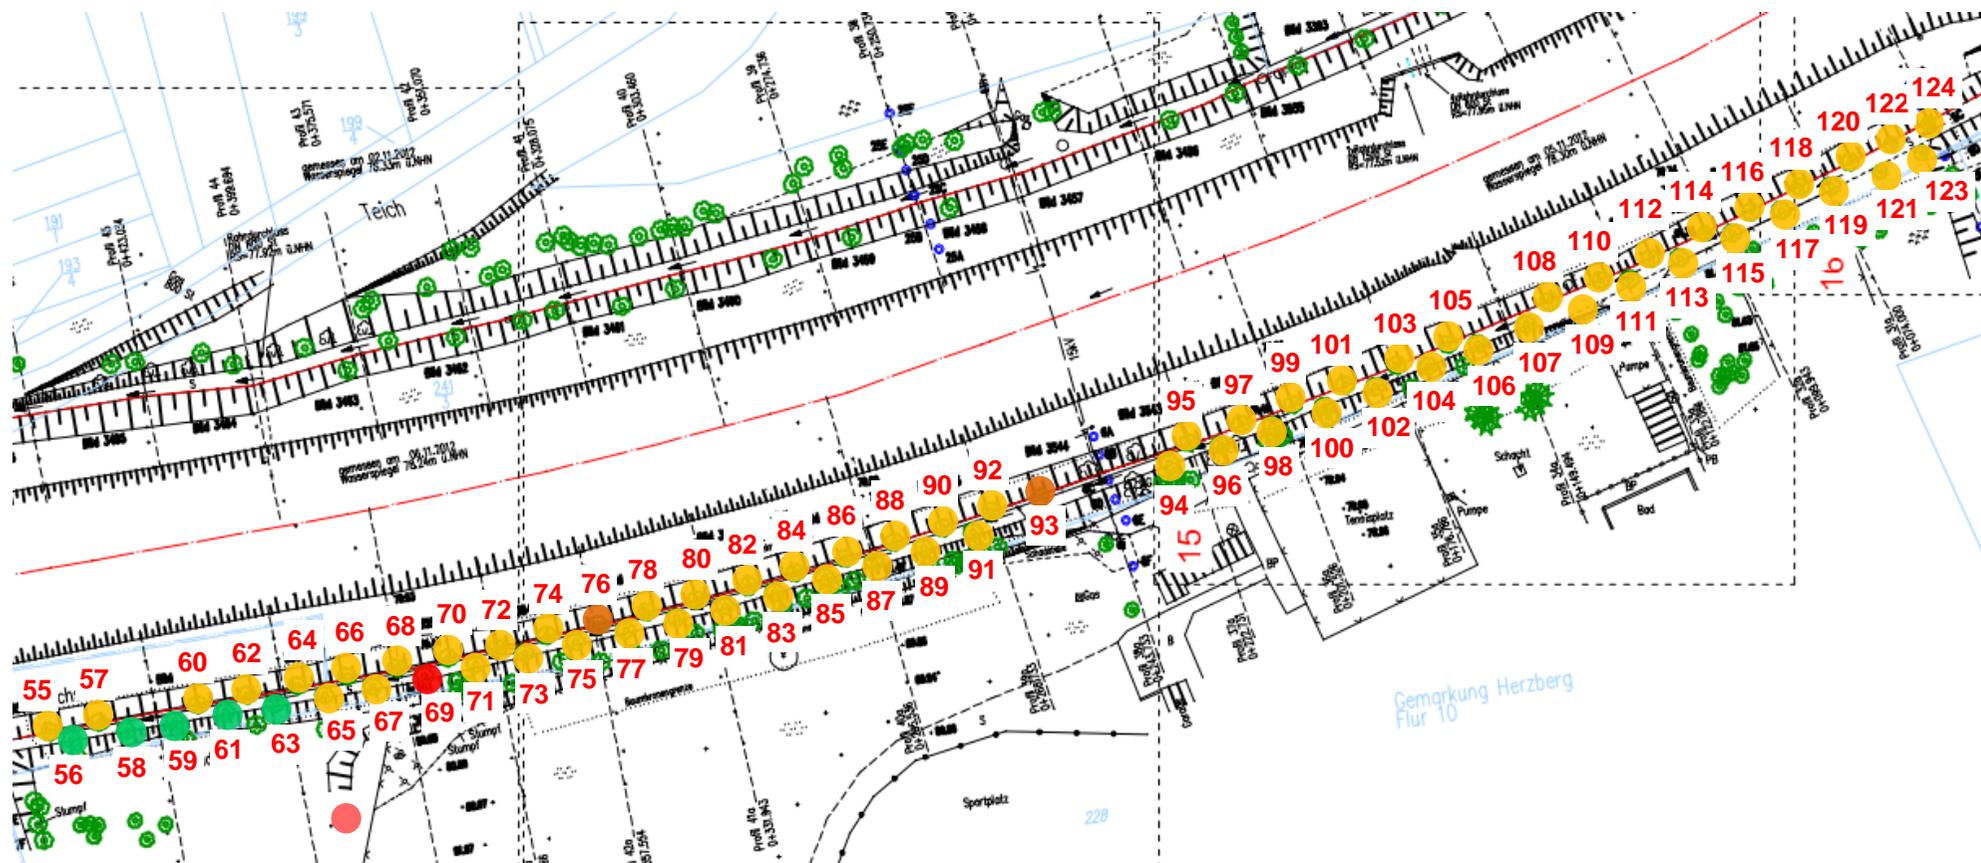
Lageplan Lindenallee, Bäume Nr. 55 – 124 (Eisenbahnbrücke bis Wehr).
